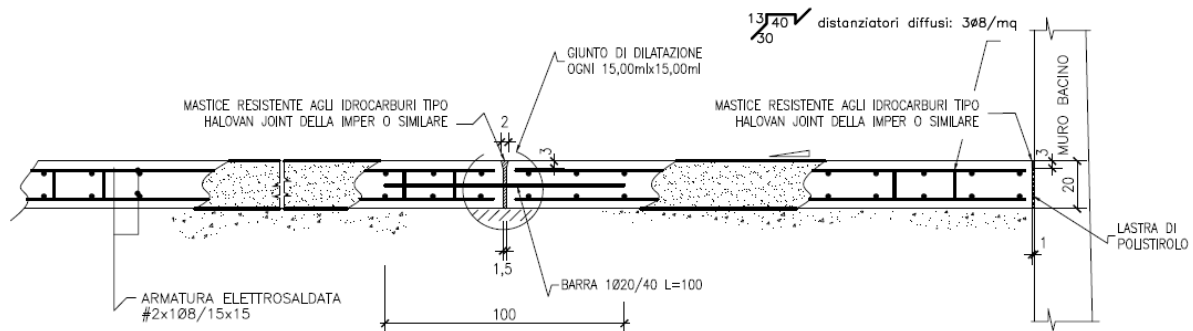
Pavimentazione bacini di contenimento – Schema costruttivo (Tip. 1)
